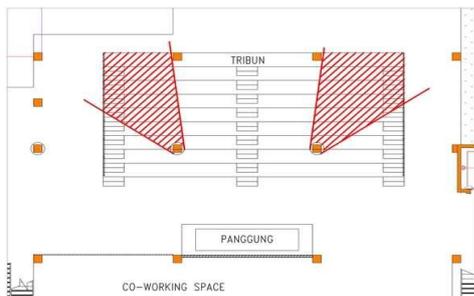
Denah amfiteater sudut pandang penonton dan panggung
